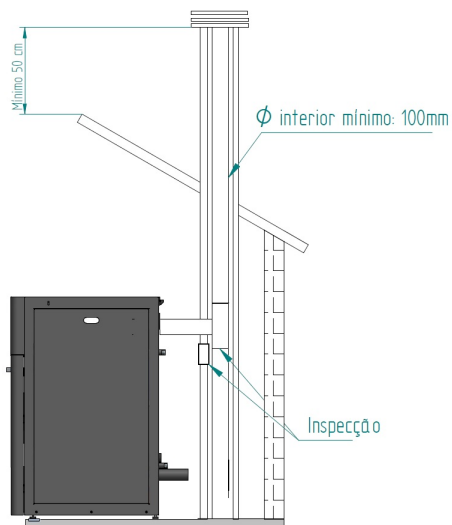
Vista lateral da instalação com chaminé, com exemplo do ponto de inspeção
